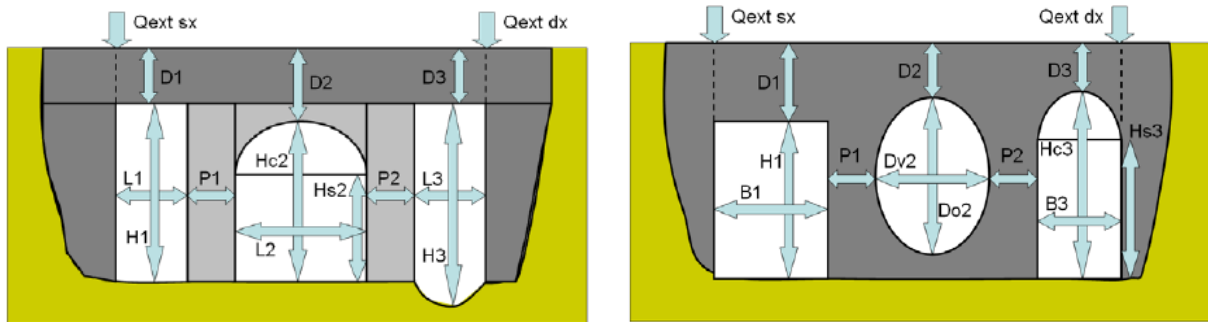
Sketch con indicazione degli elementi caratteristici della geometria trasversale del ponte (sinistra) e del tombino ovvero 'culvert' (termine in inglese utilizzato nel modello) (destra)
